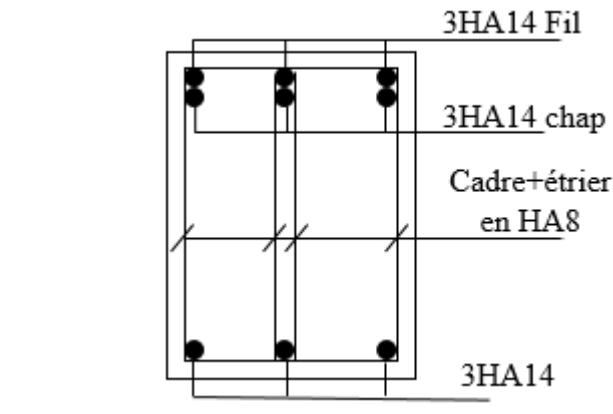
Ferraillage aux appuis d'une poutre secondaire.
